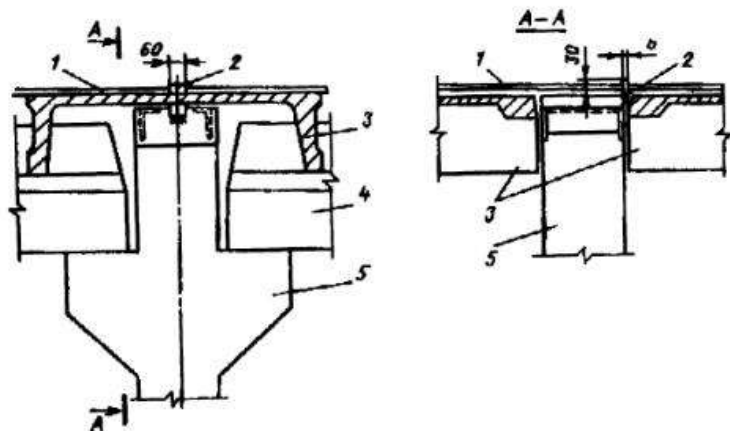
Вариант соединения молниеприемной сетки с арматурой колонны:
